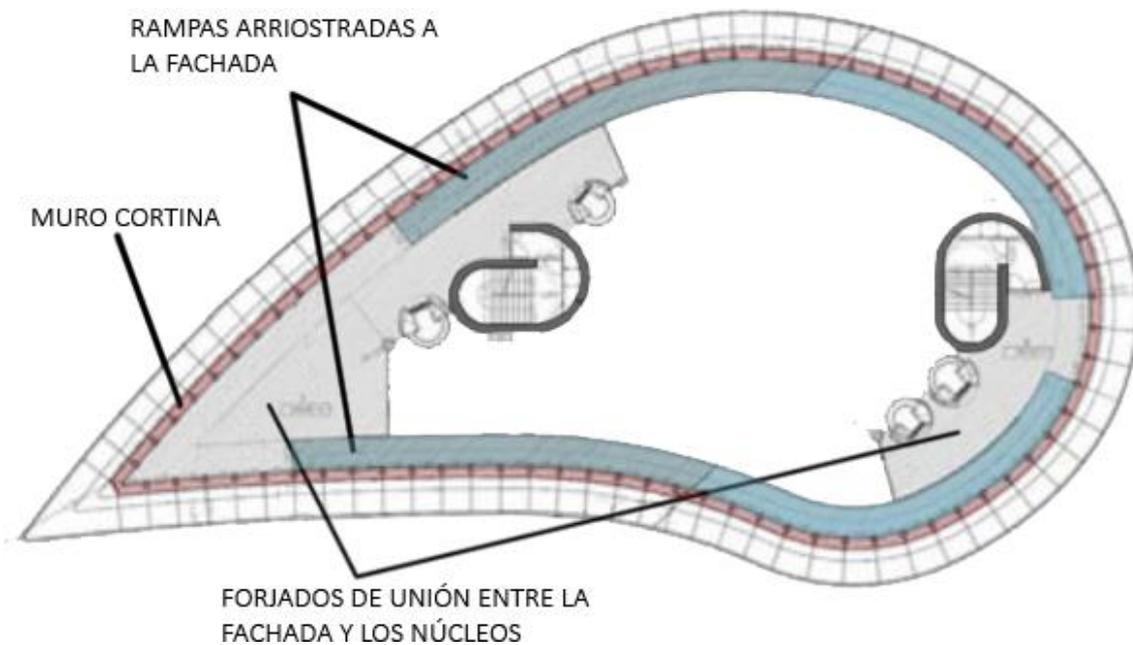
Esquema del conjunto estructural en planta. Elaboración propia.
